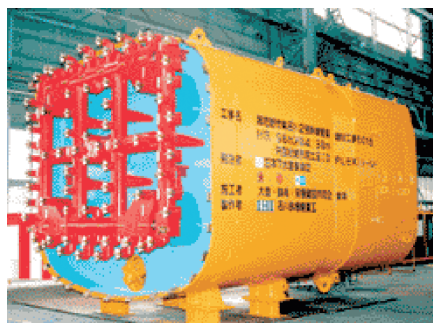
da [11] - Narashino: Costruzione del tunnel canale Kikutagawa. Scudo EPB rettangolare dimensioni: 4,38 m x 3,98 m.
